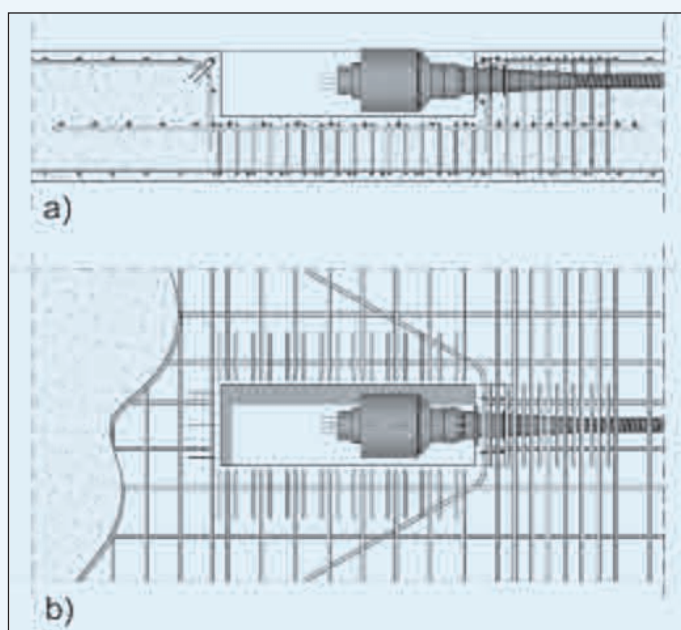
Un dettaglio della nicchia all'estradosso dell'impalcato per l'ancoraggio e tesatura dei cavi: a) sezione; b) pianta
